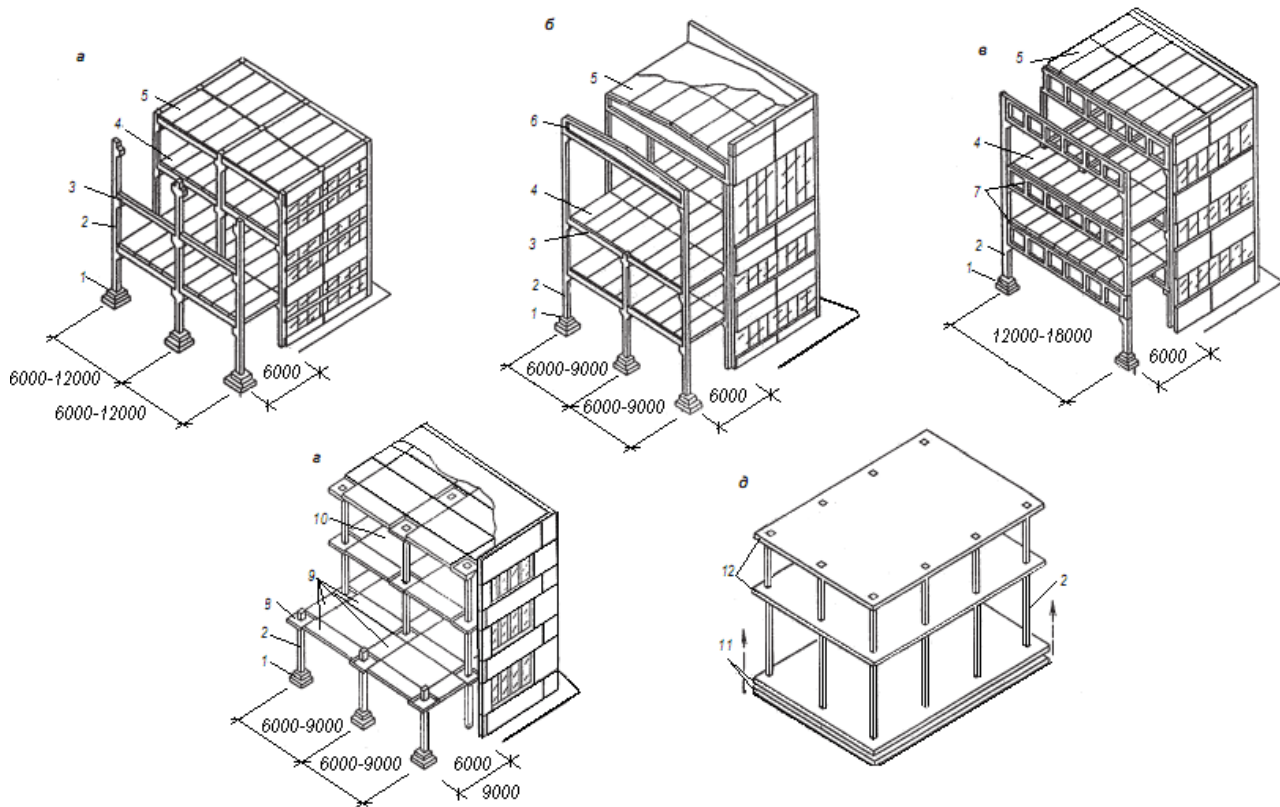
Залізобетонні каркаси багатоповерхових будівель: а – стійково-балковий; б – стійково-балковий зі збільшеним верхнім прольотом; в – великопролітний; г – безбалковий; д – з монолітним перекриттям; 1 – фундамент, 2 – колони; 3 – ригелі; 4 – плити перекриття; 5 – плити покриття; 6 – кроквяні балки; 7 – безрозкосні ферми; 8 – капітель; 9 – надколонні плити; 10 – пролітна панель; 11 – «пакет» перекриття; 12 – перекриття, поставлені в проектне положення
